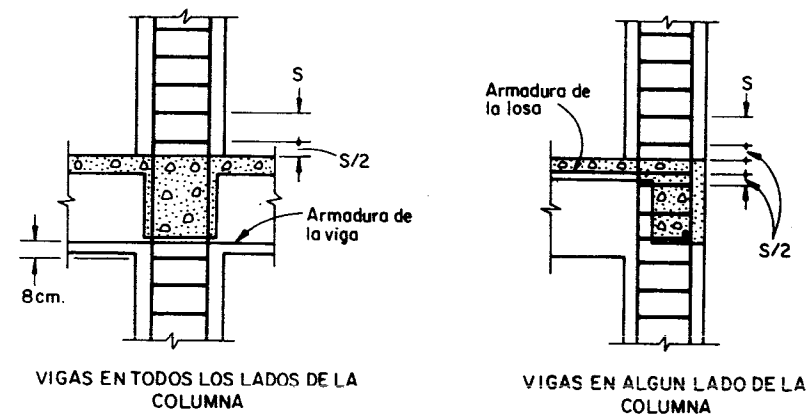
ARMADURA TRANSVERSAL EN COLUMNAS
